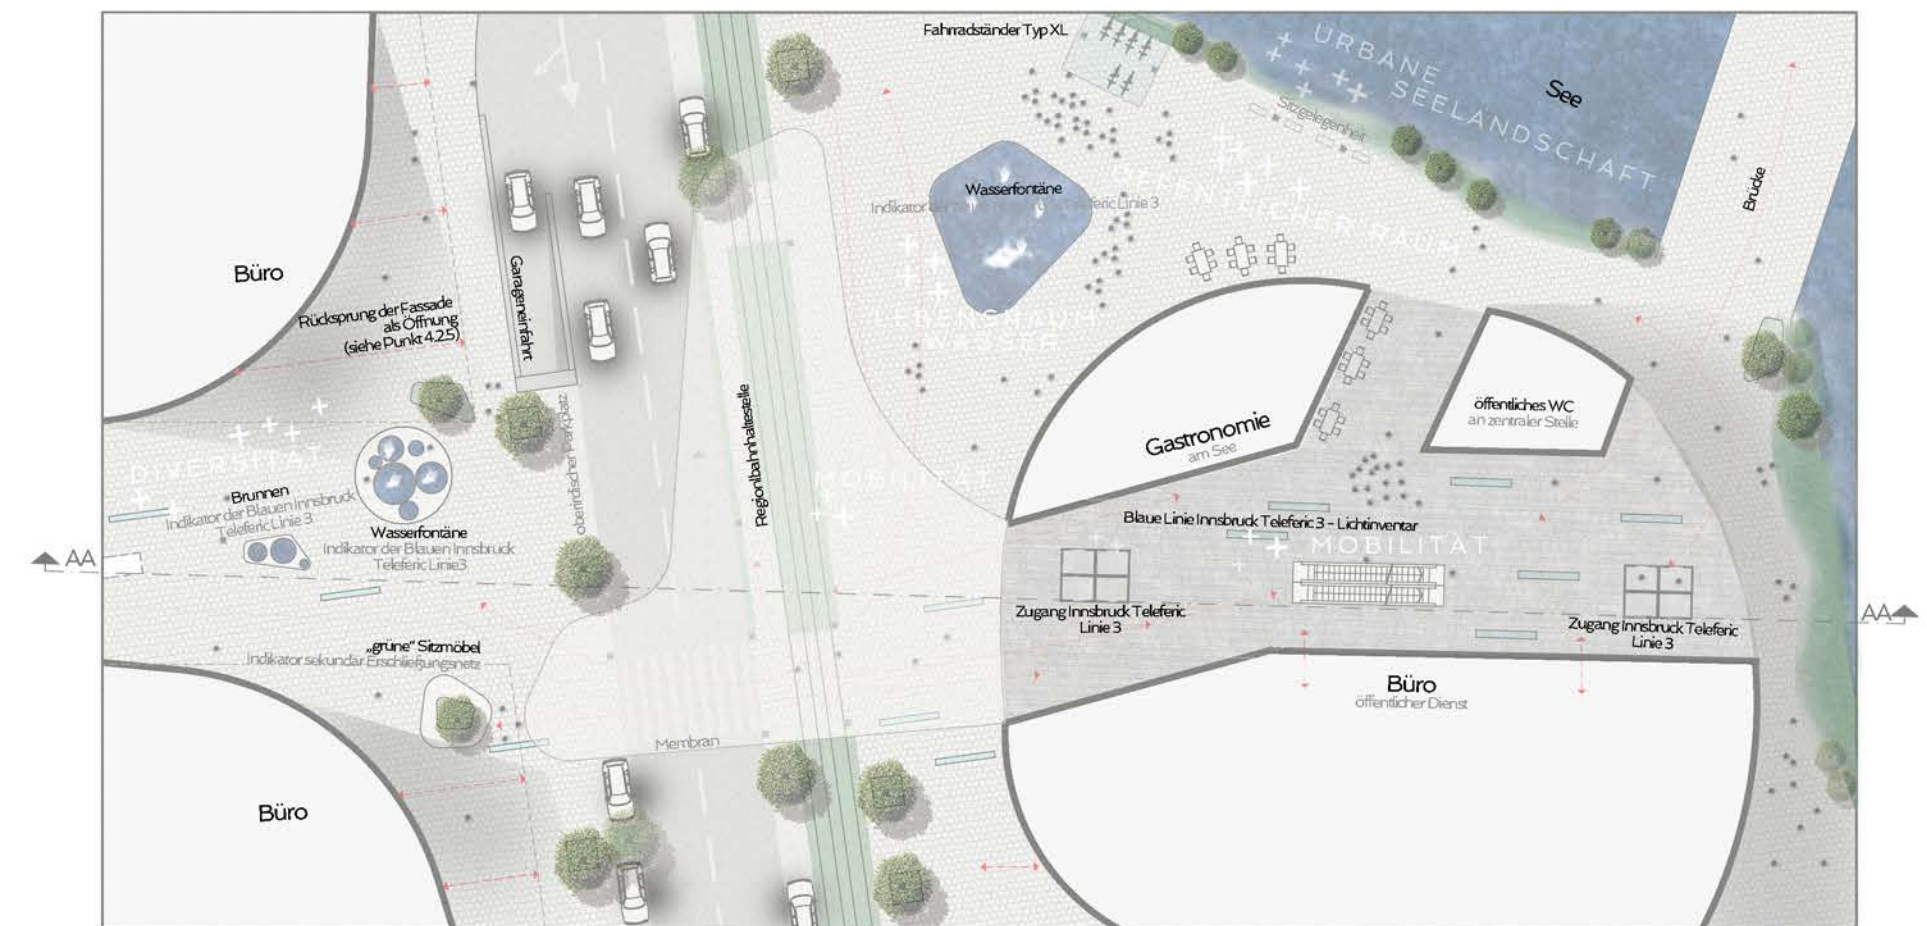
Prinzipgrundriss EG - Plan01 1:500
